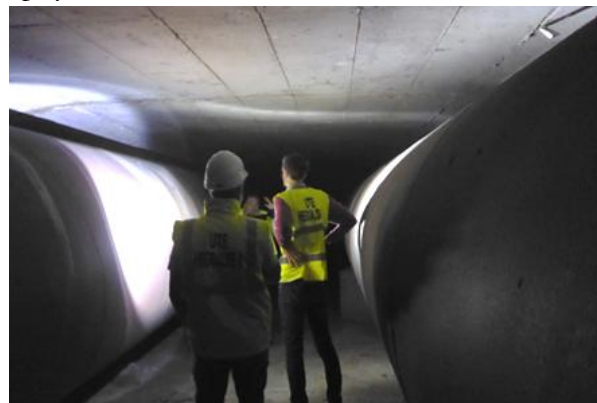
Interior de la sección cajón del acueducto y tuberías de 1800 mm de diámetro.
